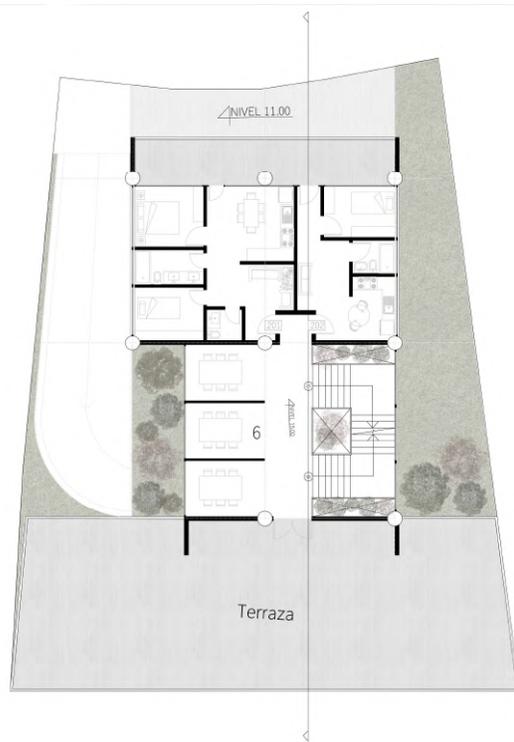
Primera Planta Nivel 15.00 Vivienda multifamiliar. Elaboración Propia
